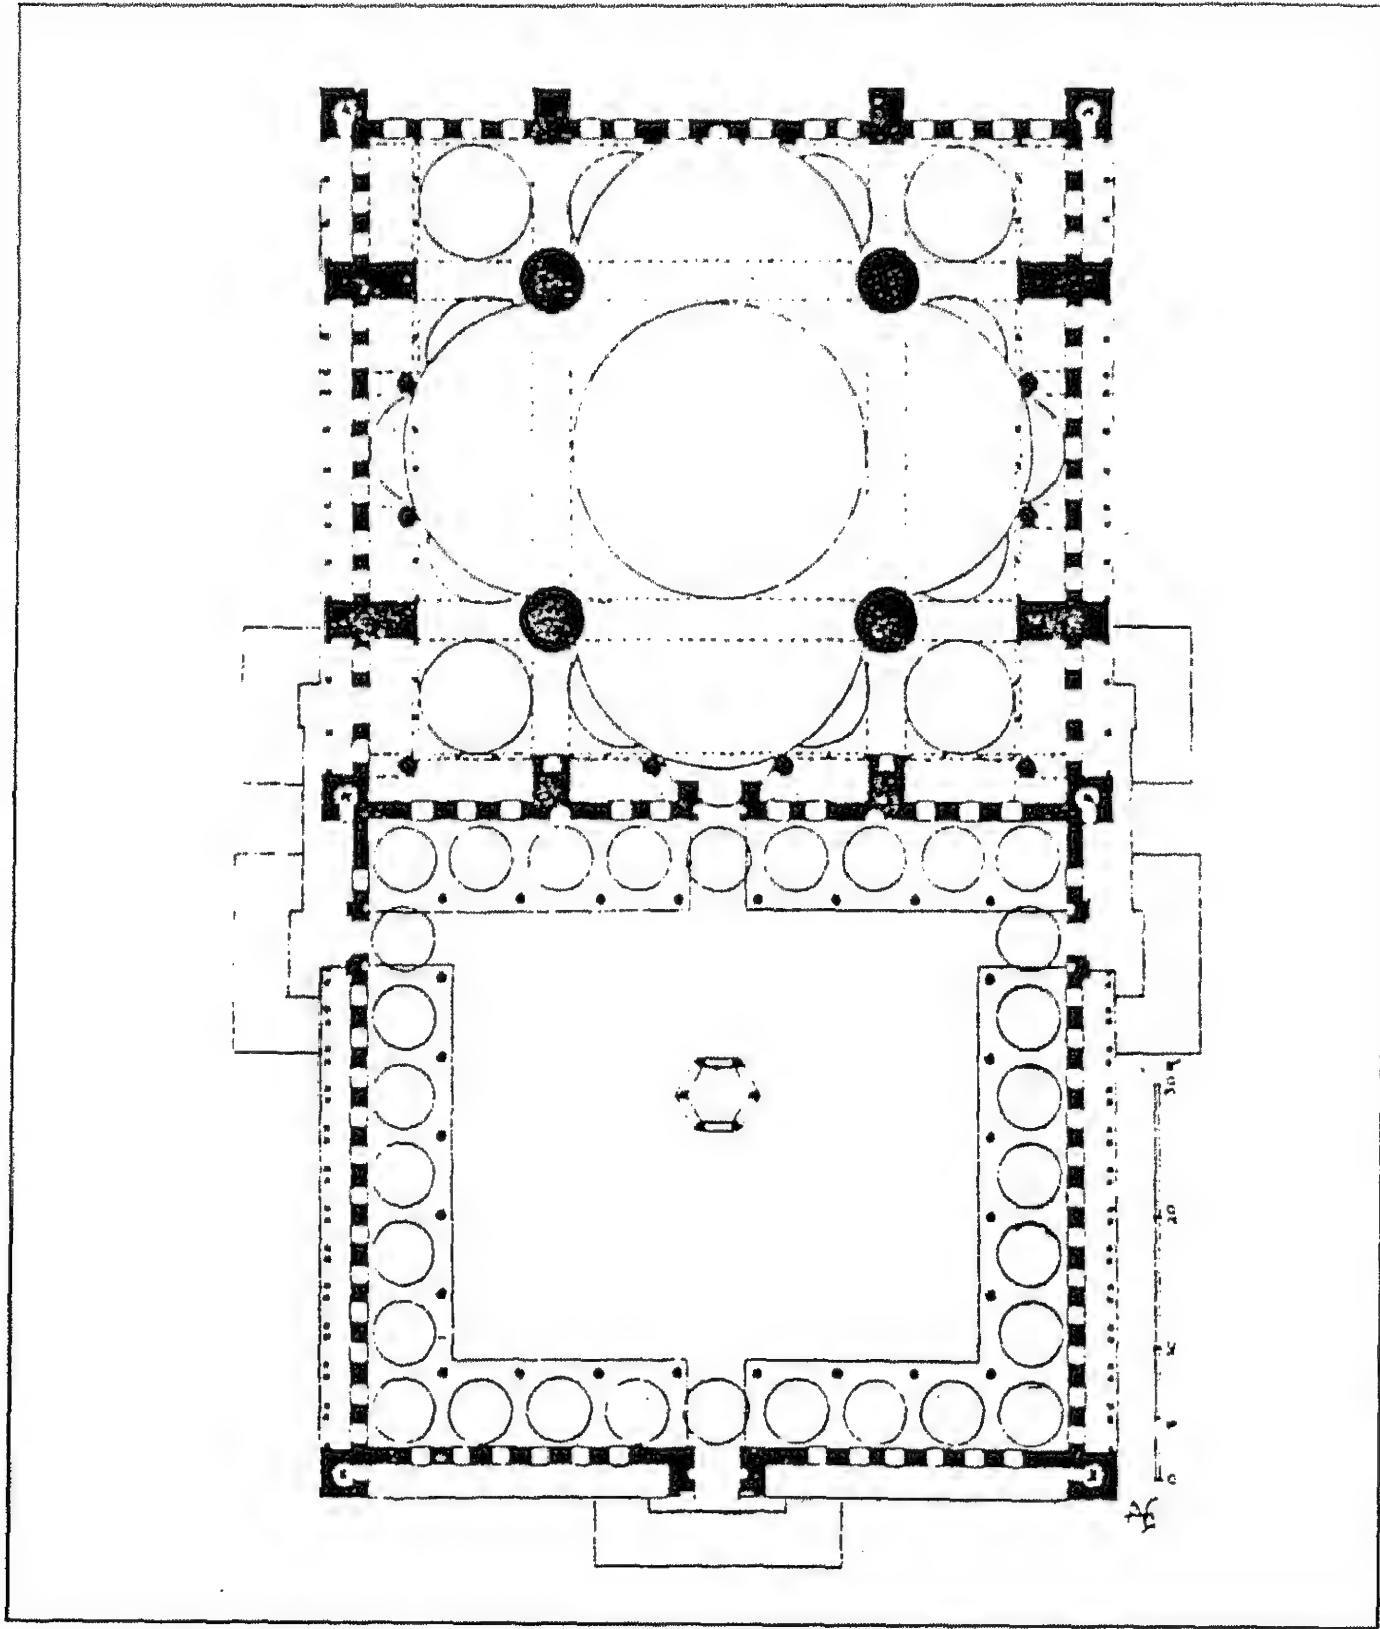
مسقط أفقي لمجمع السلطان بايزيد في إستانبول (عن : جابرييل) .
